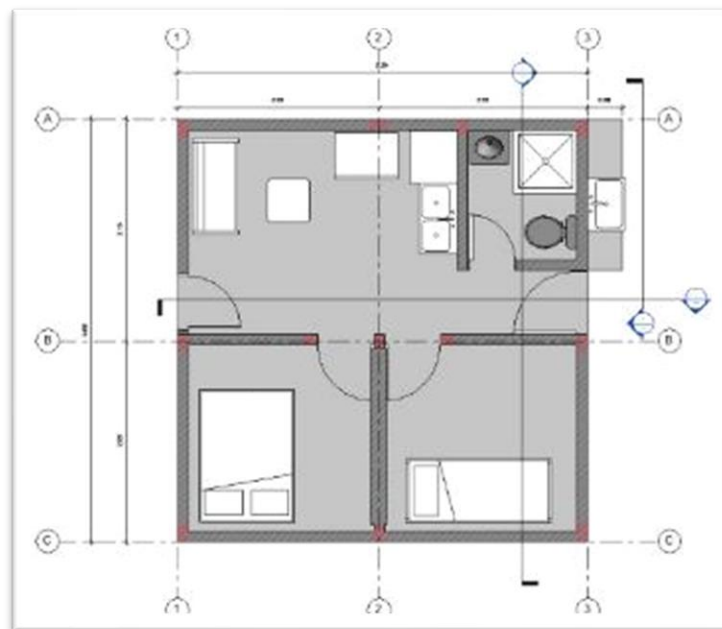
Plano en planta del módulo en la plataforma Revit. Fuente: Propia.
